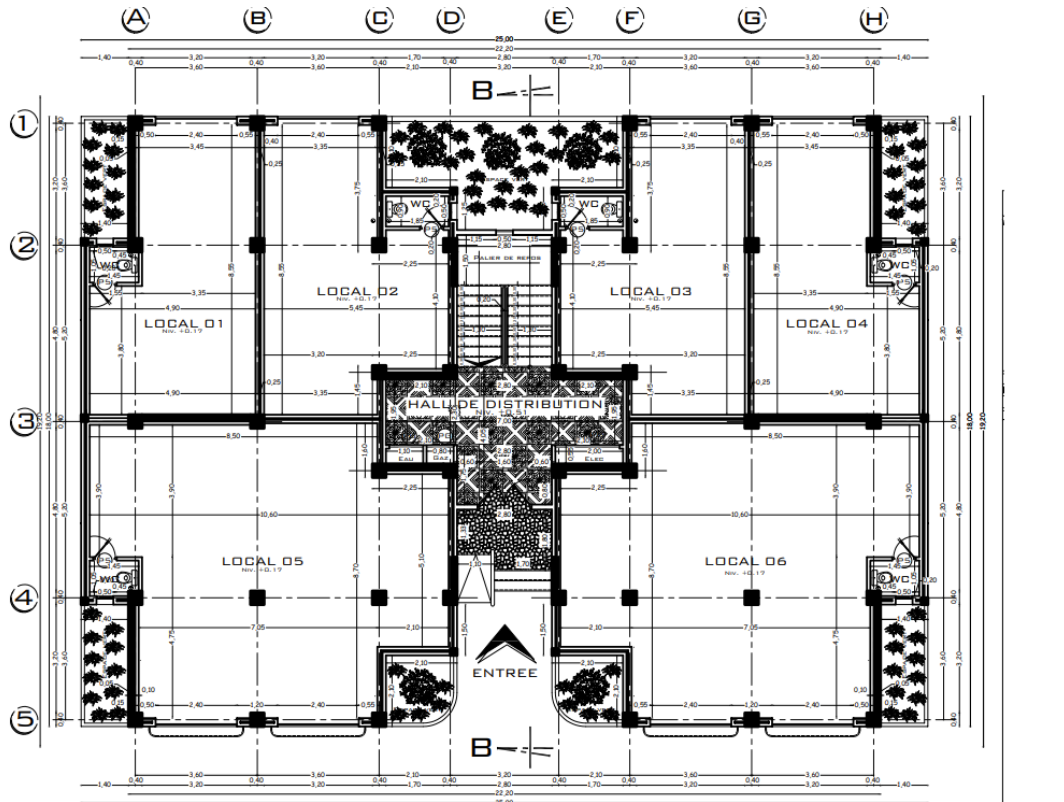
PLAN RDC TYPE 01 (LOCAUX COMMERCIAUX)
